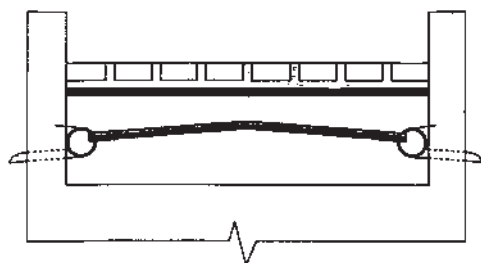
Princip funkce horizontální hydroizolační konstrukce. (Kresba R. Moudrý)
